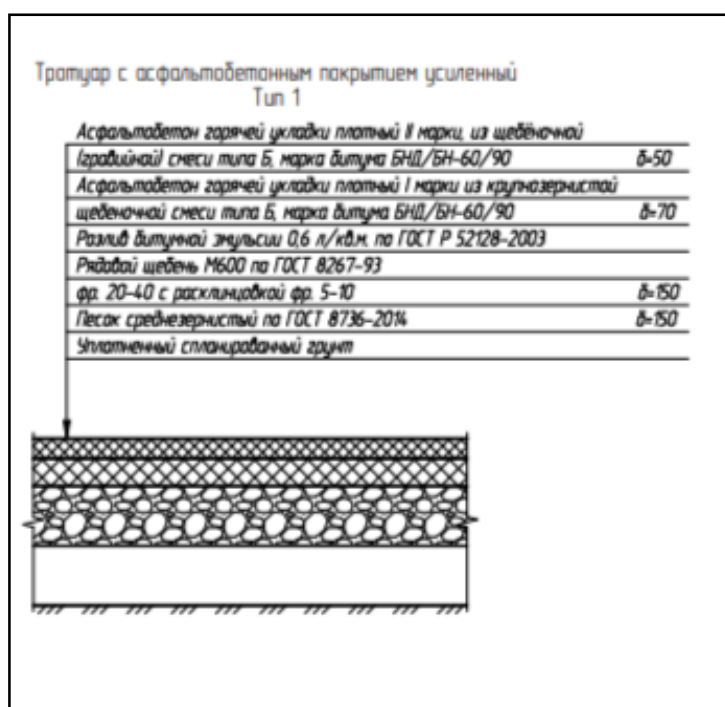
Устройство тротуара с асфальтобетонным покрытием. Тип 1
